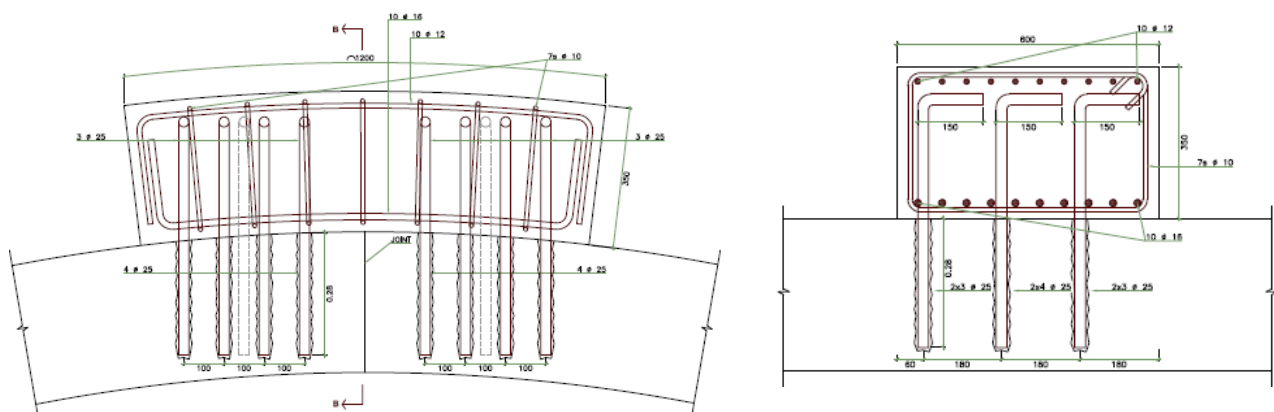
Refuerzo de trasdós mediante bloque de hormigón
